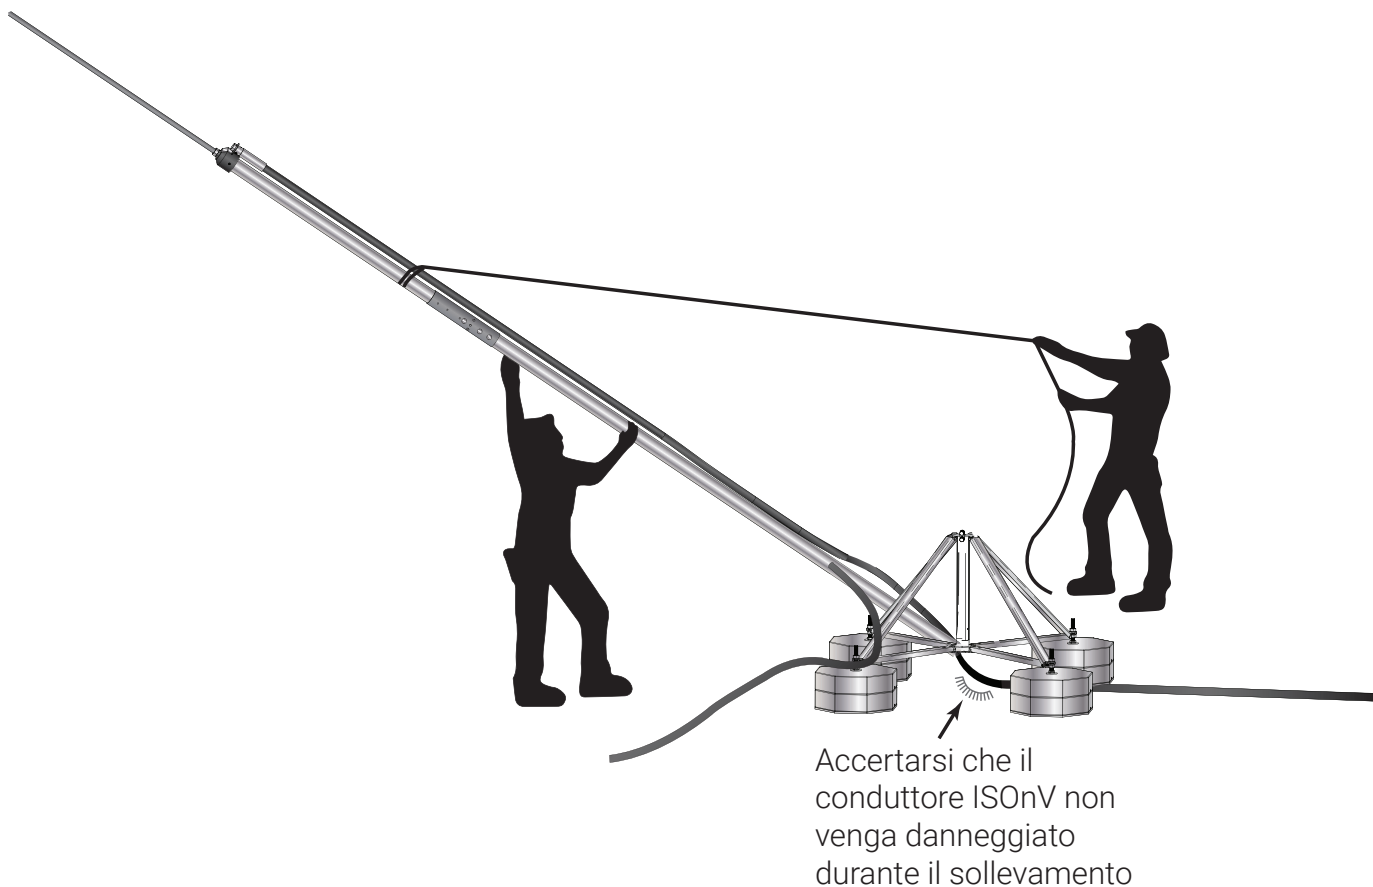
Sollevare il palo adottando pratiche di lavoro sicure
